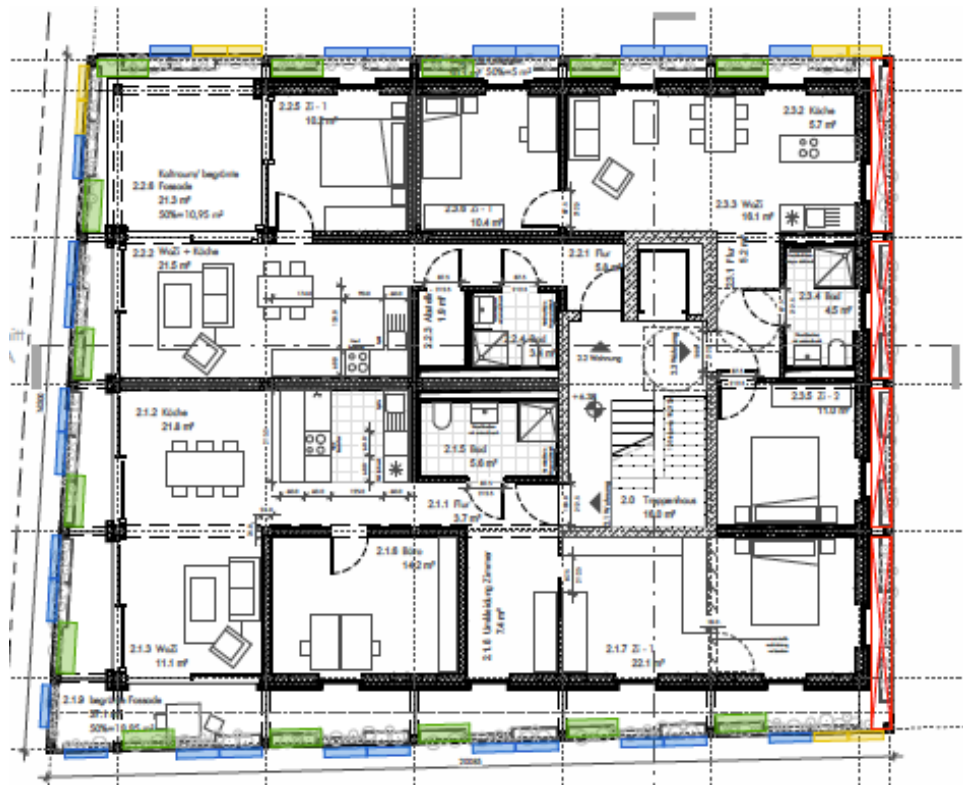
Grundriss des 2. Obergeschosses. Grüne und blaue Felder markieren die alternierenden Flächen der Gerüstklettopflanzen und der „kleinen Gärten“ mit Individualbepflanzung. [© DGJ Architektur GmbH]
